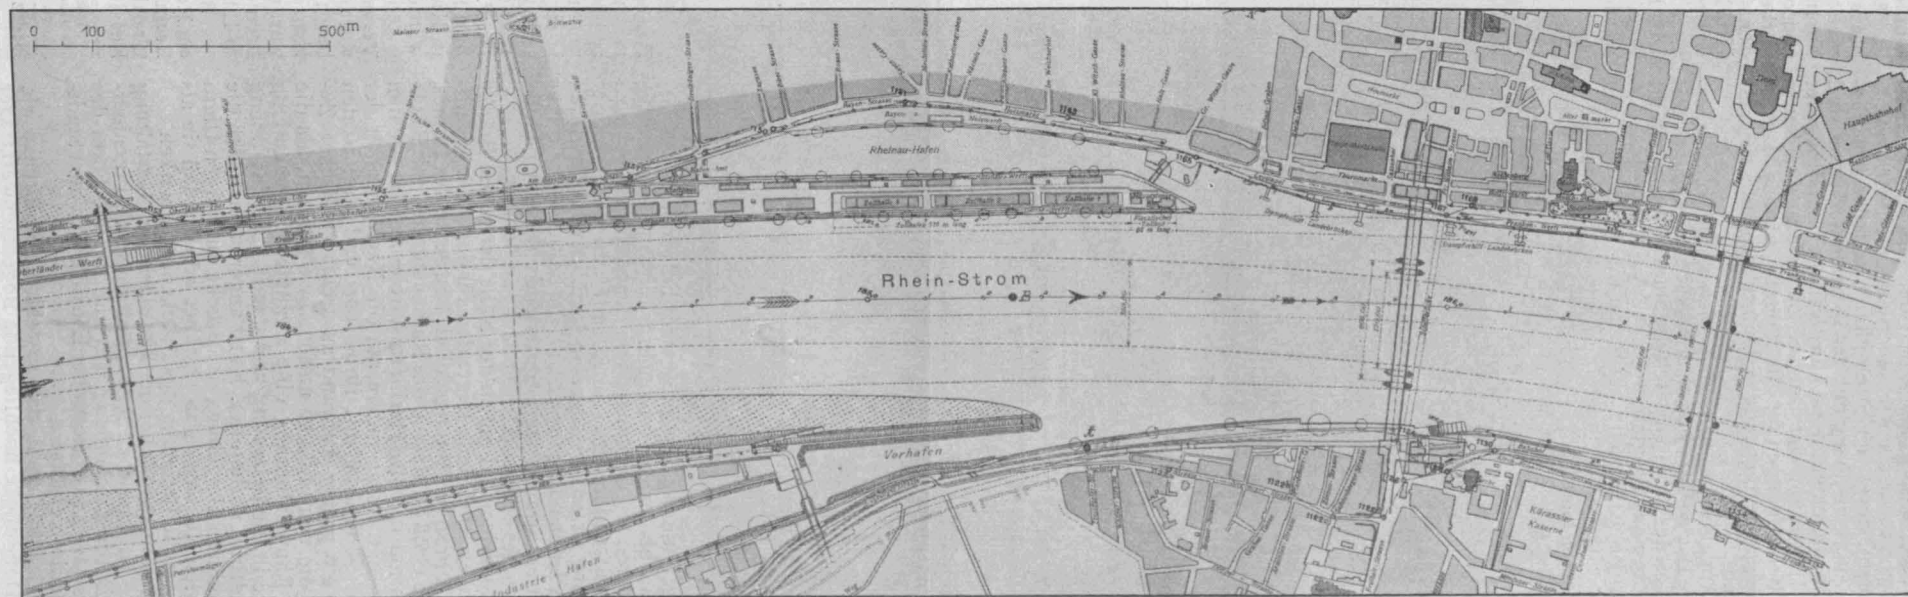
Lageplan der neuen Straßenbrücke anstelle der alten Schiffbrücke. Abbildung 2 (oben). Stadtbild vom Punkt B des Lageplanes mit Blick gegen die umgebaute Dombrücke, Wettbewerb Straßenbrücke über den Rhein in Cöln.
